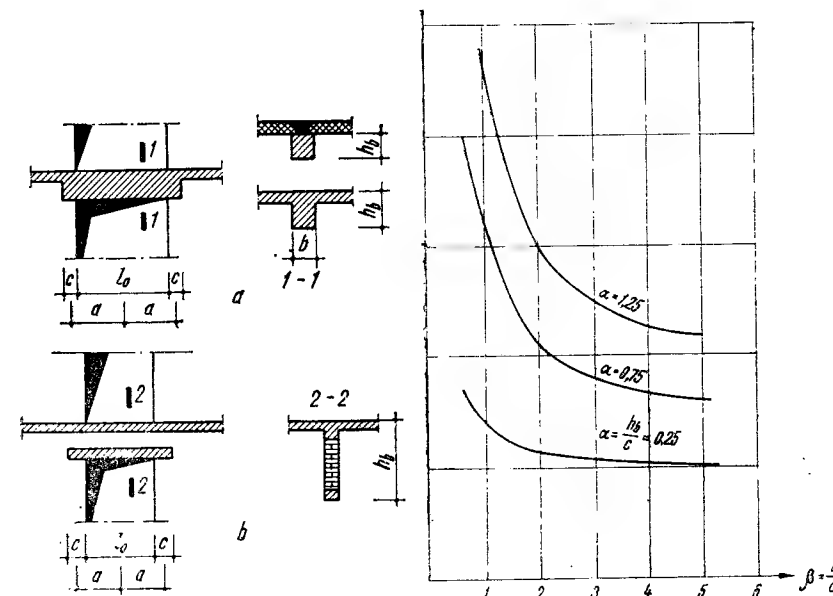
Stabilirea deschiderii și înălțimii de calcul a buiandrugilor : a — pentru buiandrugii din beton armat monolit sau din elemente prefabricate ; b — pentru buiandrugii din beton armat amplasați sub centură ; c — variația coeficientului λ cu raportul l_0/c .
